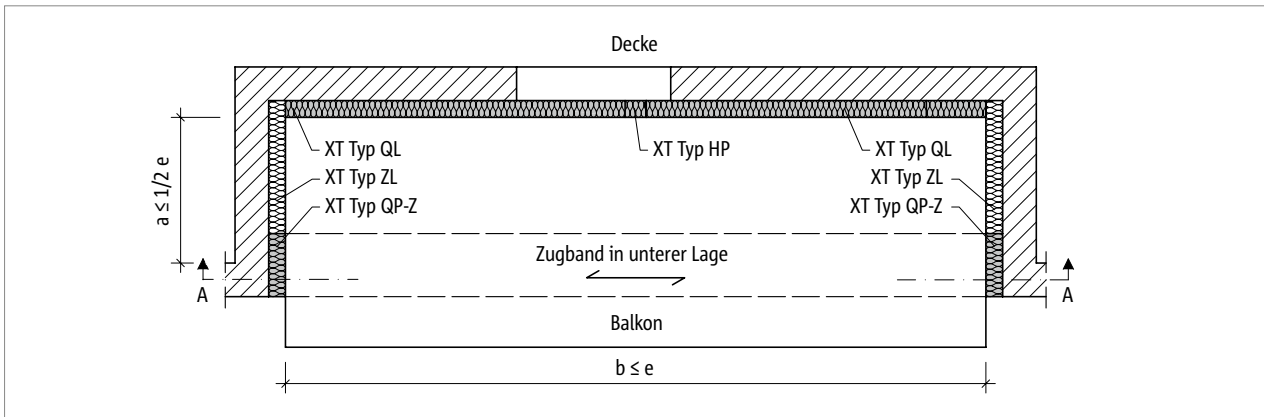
Schöck Isokorb® XT Typ QP-Z: Grundriss Loggia - symmetrisch
